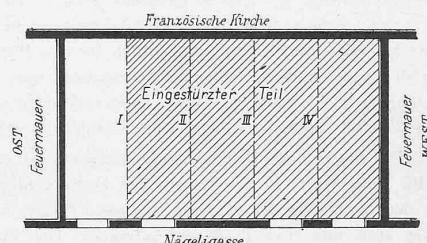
Grundriss des eingestürzten Teiles.
